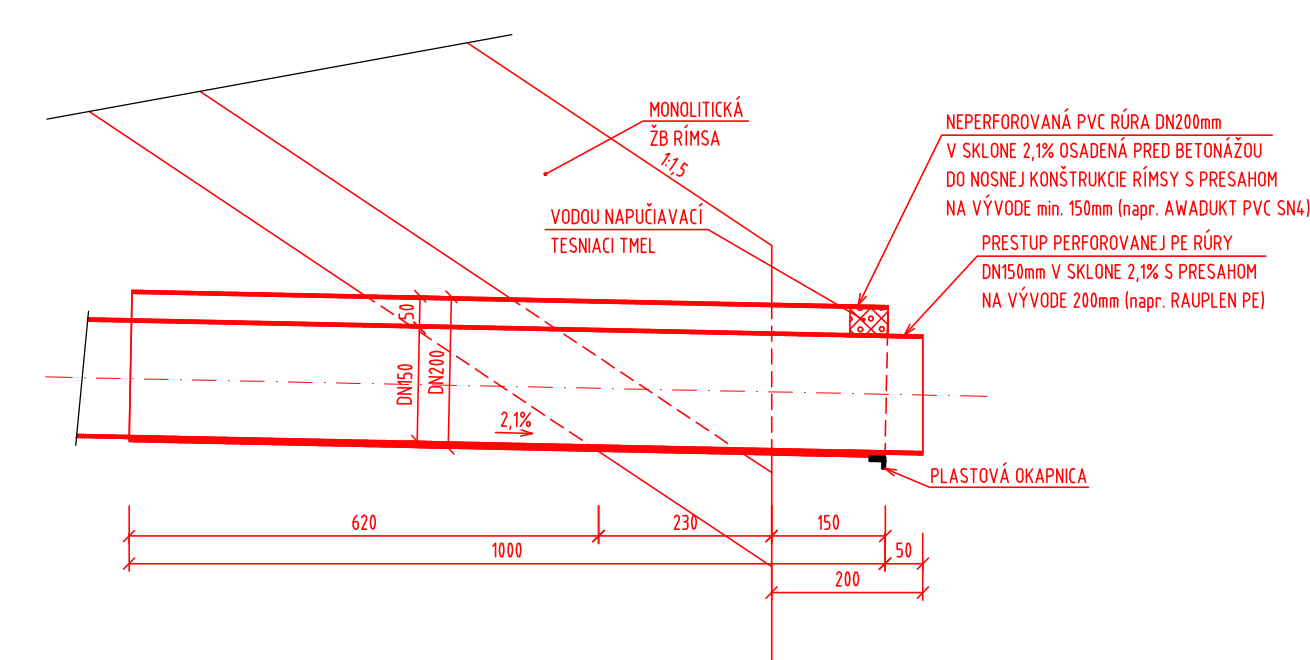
DETAIL PRESTUPU ODVODNENIA RÍMSOU NA VTOKU
